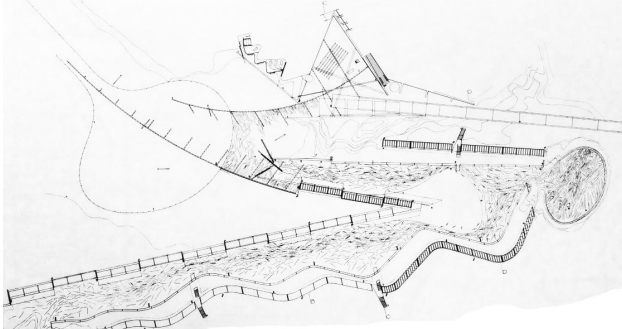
Planta del Cementerio de Igualada_Barcelona..
